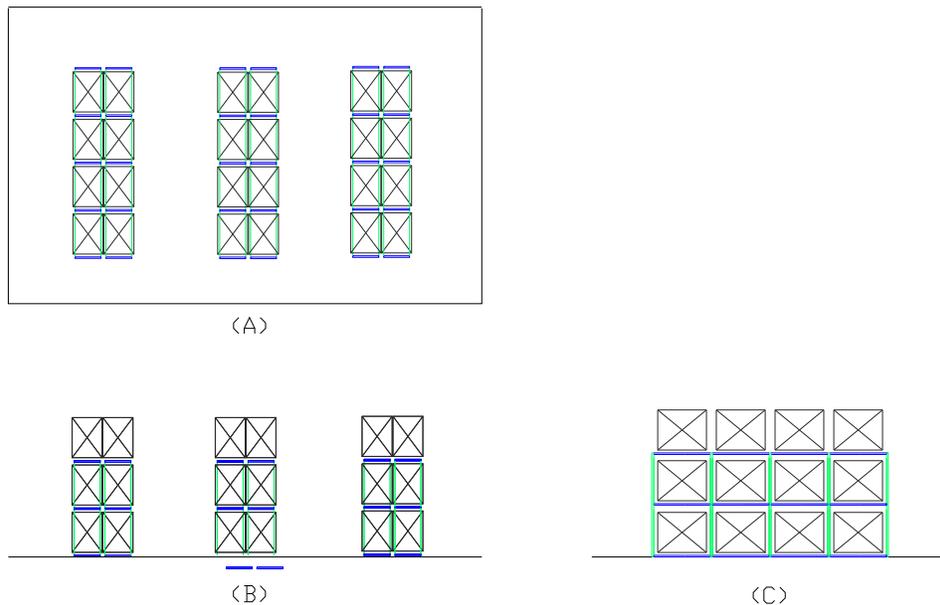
Estrutura de Armazenagem – Porta Pallet (A – Vista Superior, B – Vista Lateral, C – Vista Frontal)
